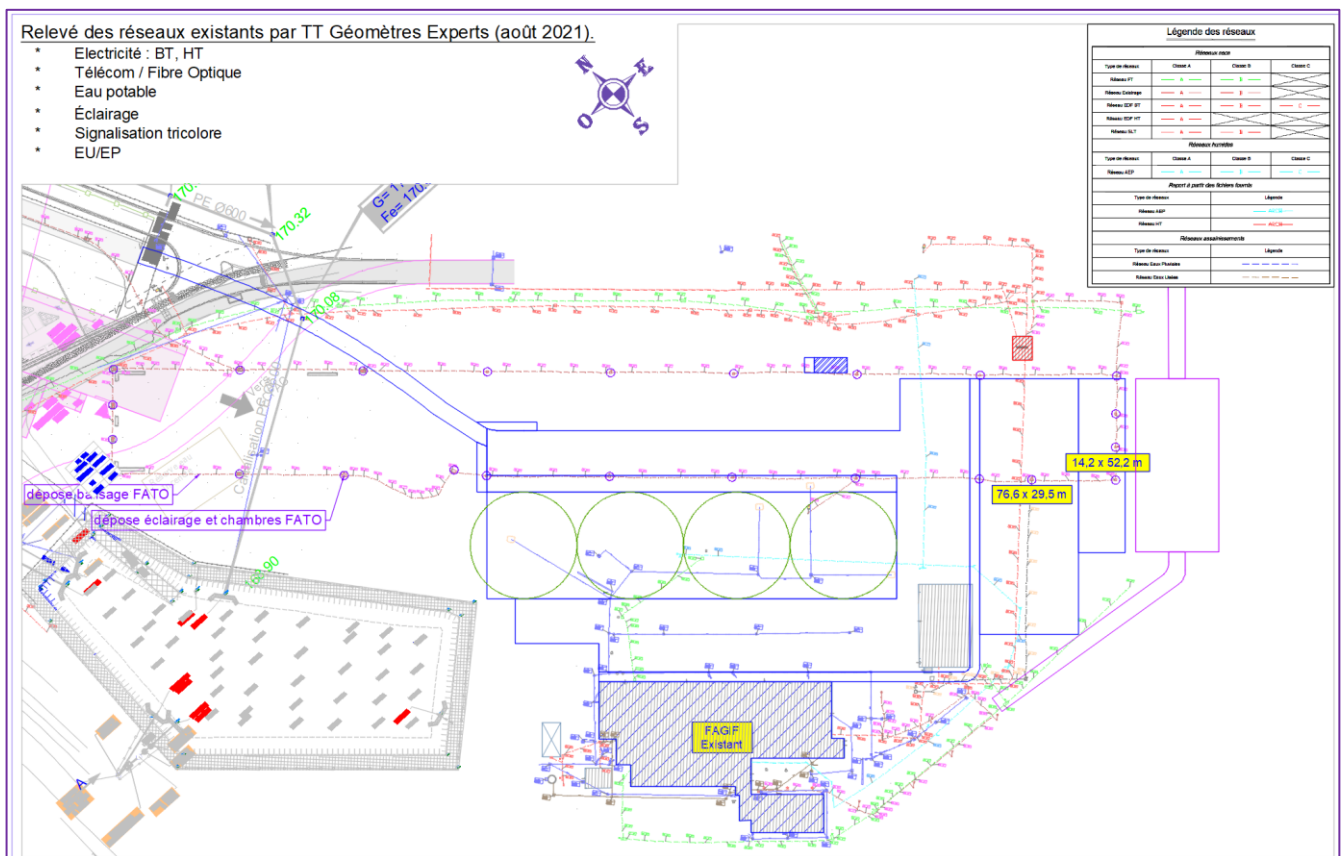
plan des réseaux d'après relevé TT géomètres d'août 2021 (extrait planche 4 annexe 1)
